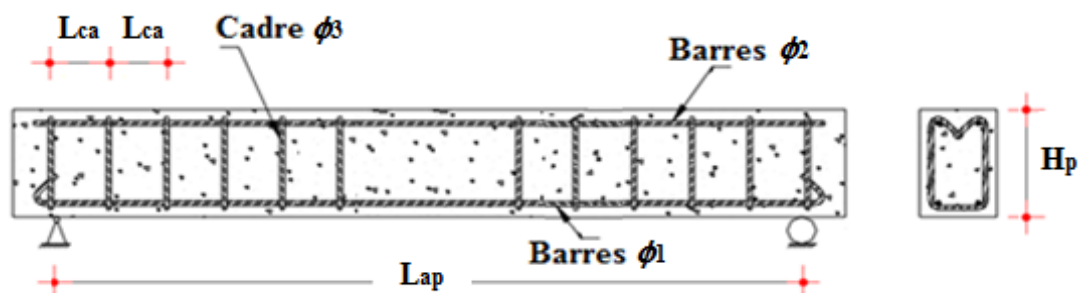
Disposition des armatures dans la poutre en béton [3]
